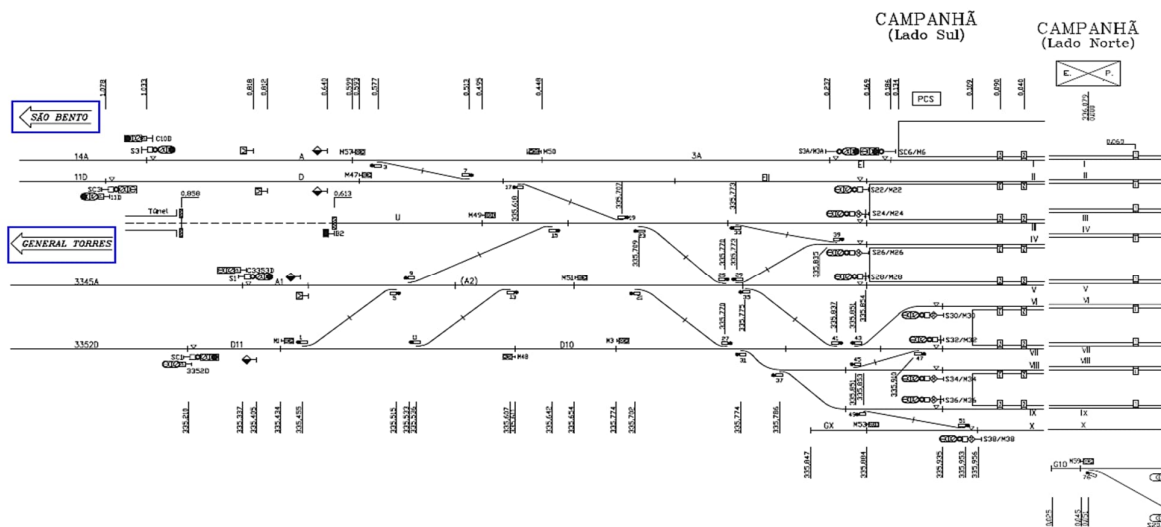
Estação de Campanhã – Situação Existente – Entrada – Lado Sul
